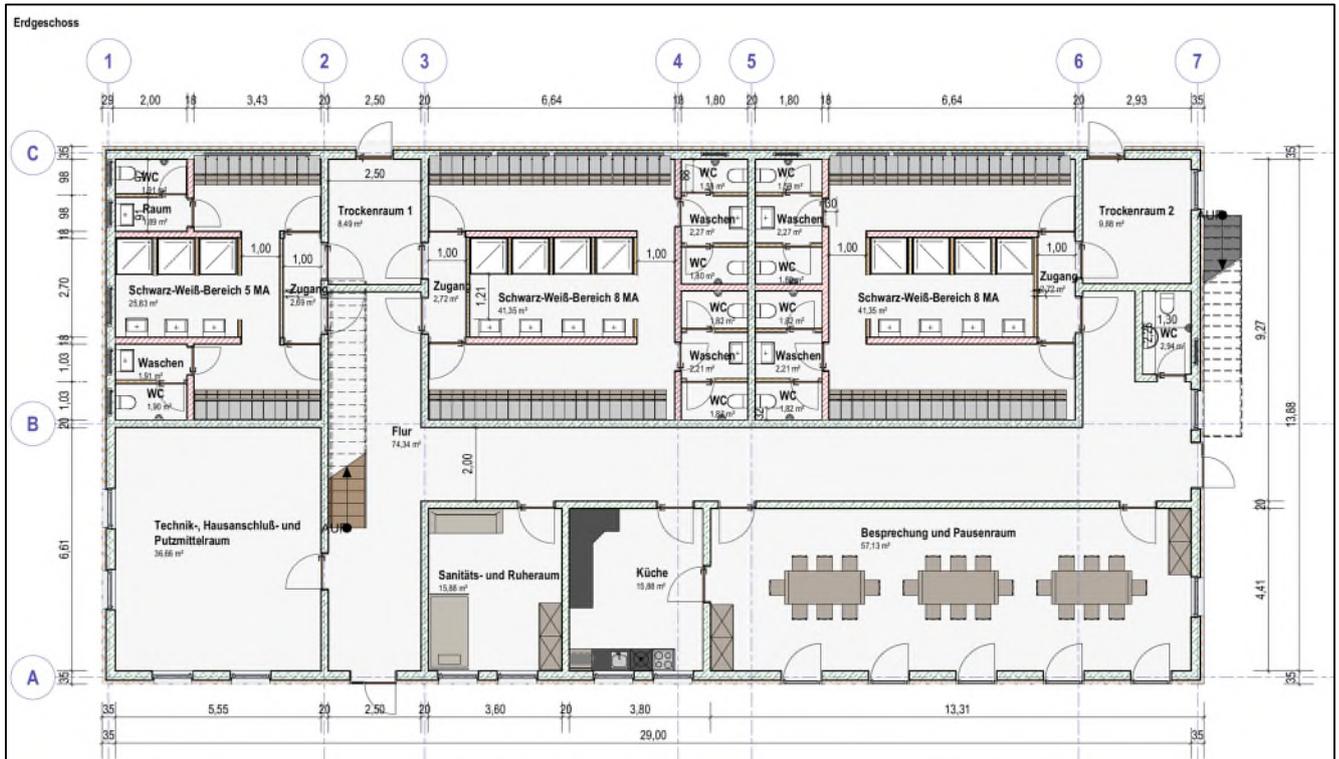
Erdgeschoss des BEZ-Betriebsgebäudes
